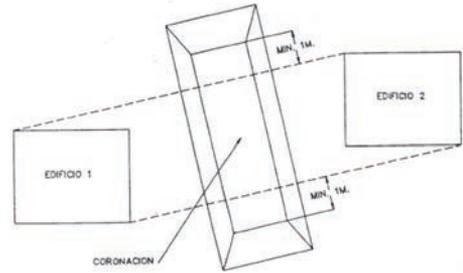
Planta de geometría que ha de cumplirse, entre elemento de protección contra explosiones entre dos edificios contiguos.
